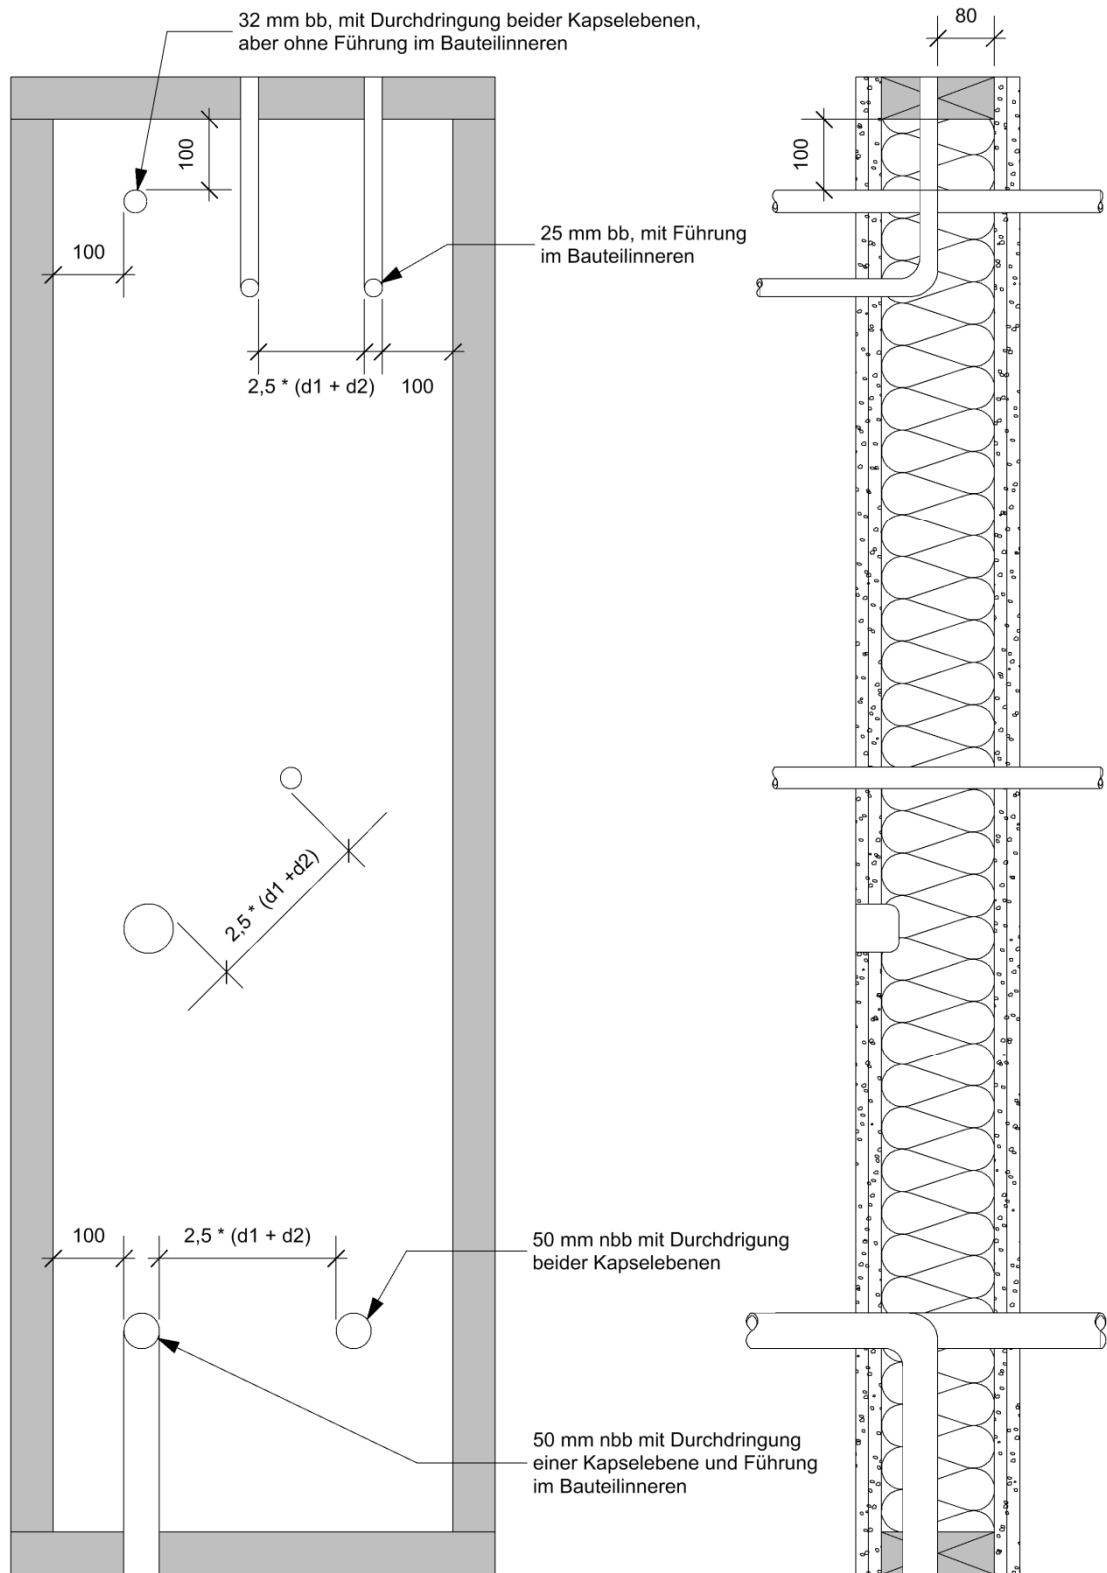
Einbau von Rohrleitungsinstallationen in Ständerbauwände, Maße in mm
